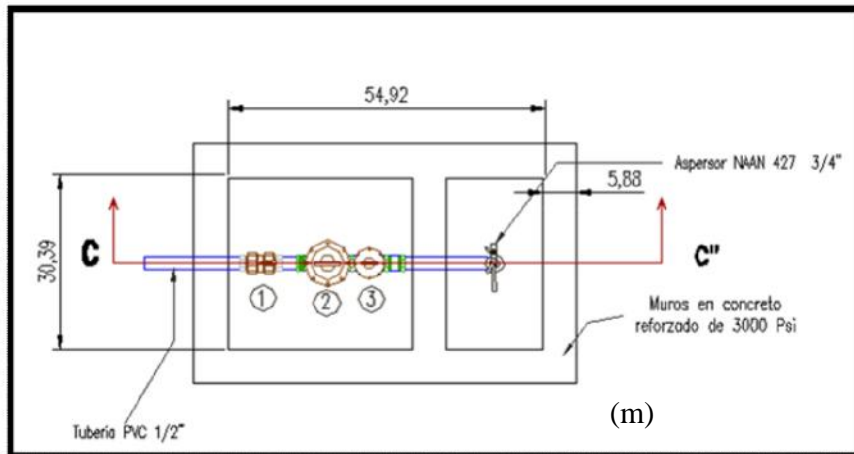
Planta-Cajilla Tipo modificada para válvulas prediales
